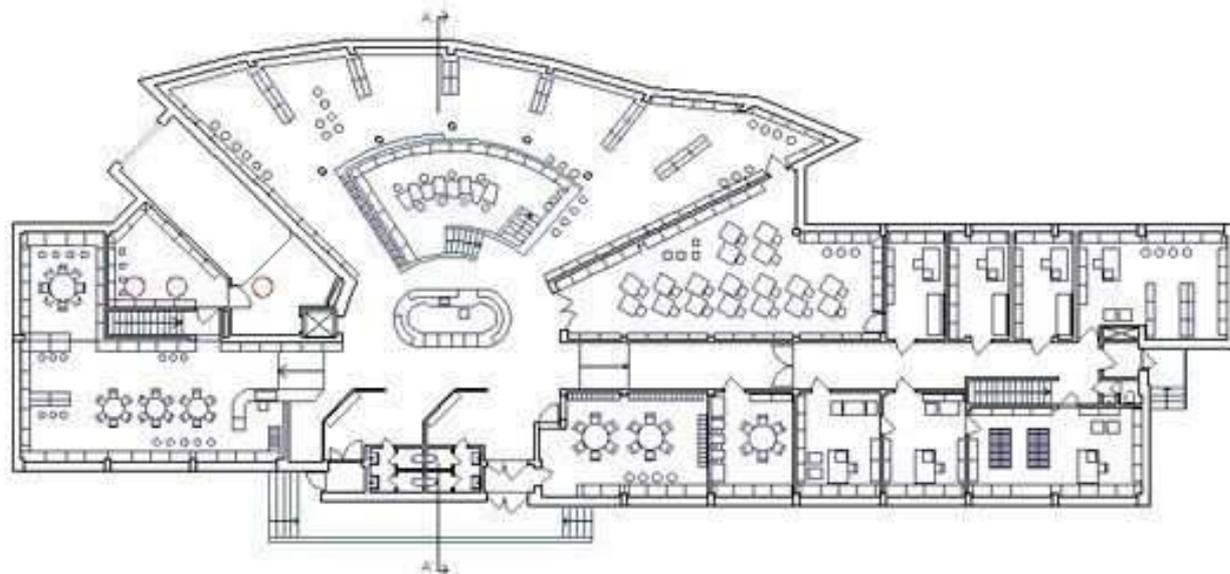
Grundriss der Stadtbibliothek Seinäjoki, 1965
